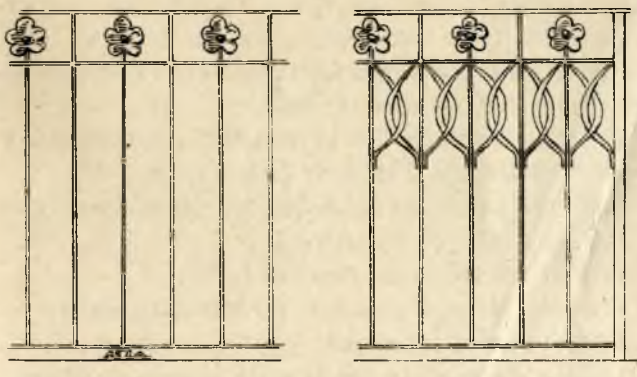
Parapetti in ferro battuto. — 1: 20.
